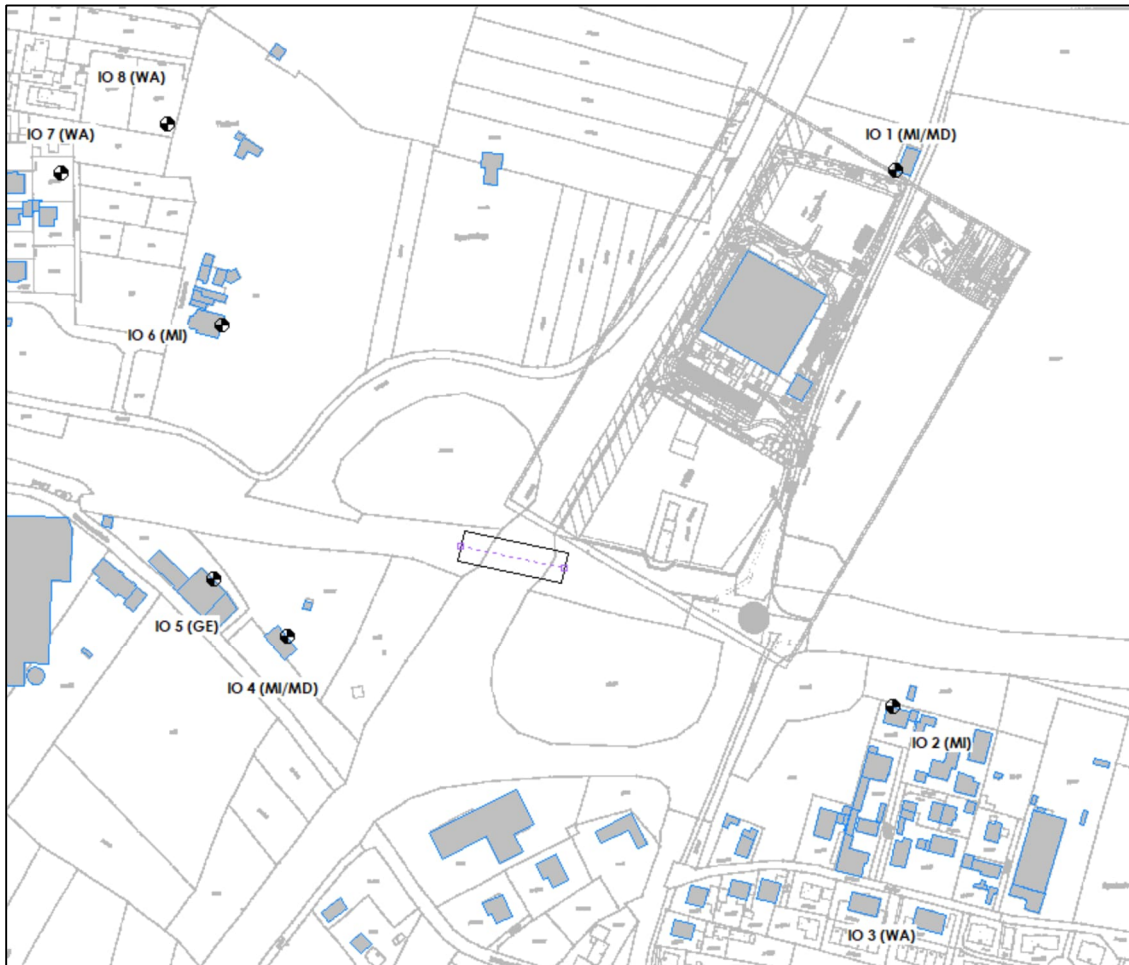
Lageplan mit Darstellung der maßgeblichen Immissionsorte IO
